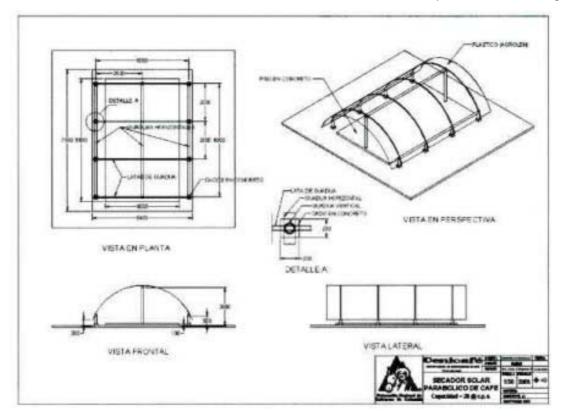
Plano de la construcción de un secador solar parabólico con capacidad para 60 @ de café pergamino seco.
